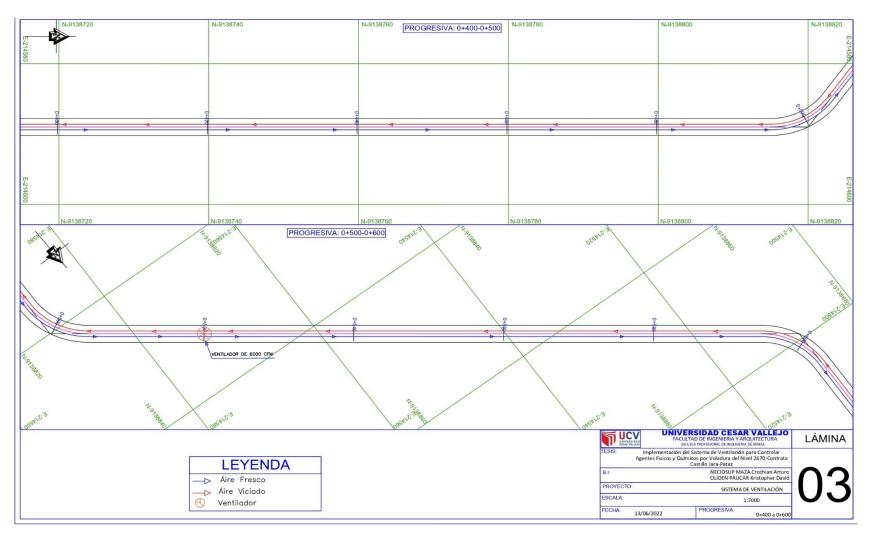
Plano en autocad del nivel 2670 – Progresiva 400-600.
